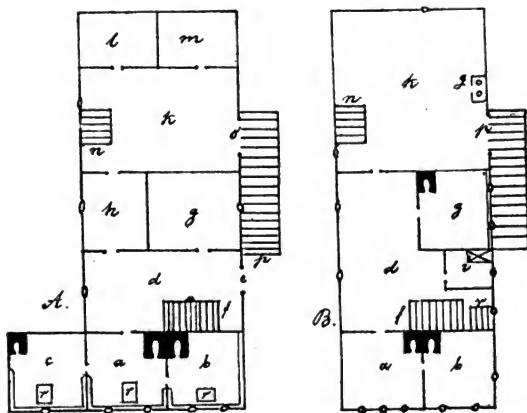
Grundrisse der beiden Stockwerke des vorigen Hauses.
